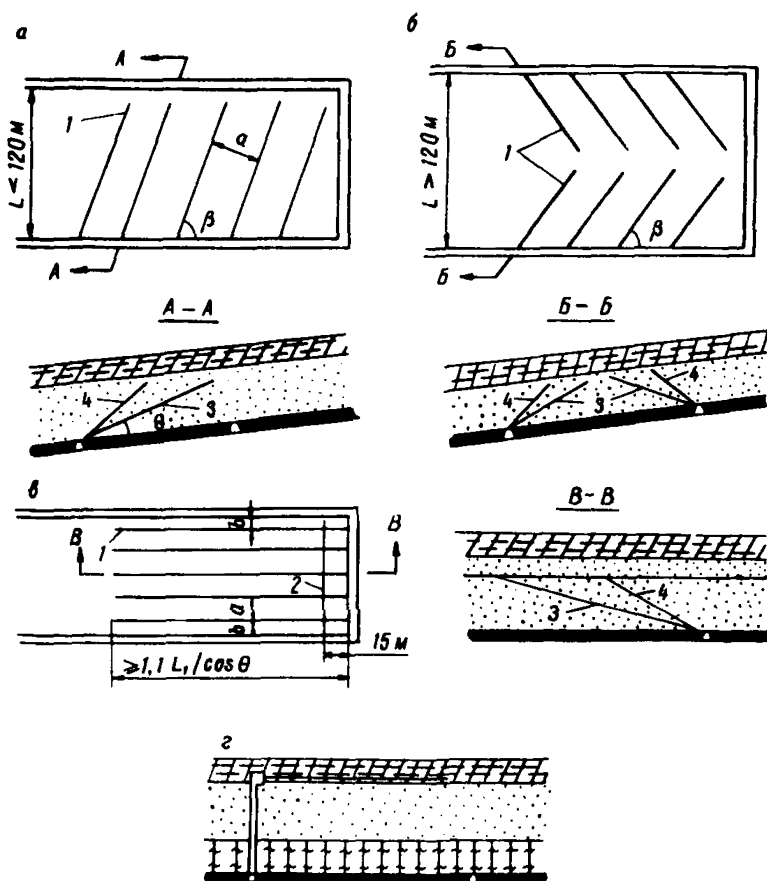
Схемы расположения скважин для разупрочнения кровли до первой осадки:
